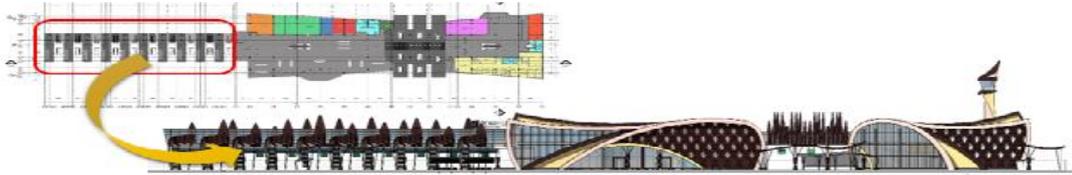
Konsep Sirkulasi Site dan Dalam Bangunan.
